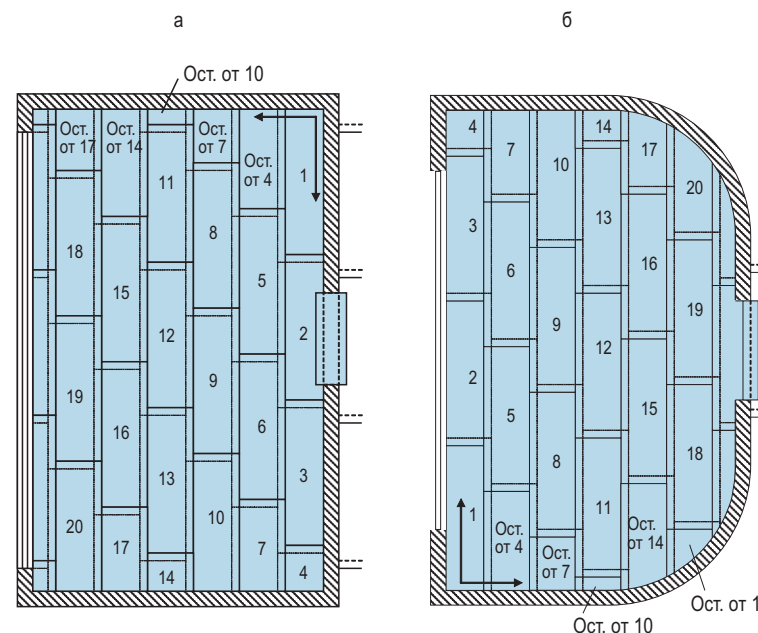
Схемы раскладки элементов пола при укладке от стены с дверным проемом (а) и при укладке от стены, противоположной дверному проему (б)
